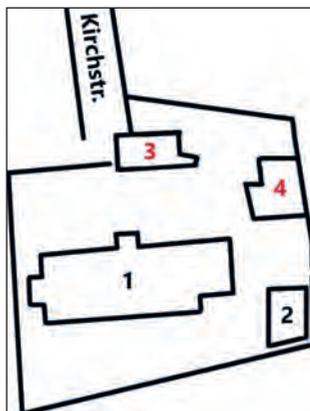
Lageplan von 2023, in diesem Lageplan wurde das nicht mehr bestehende Lehrerwohnhaus und das Schulgebäude projiziert.
